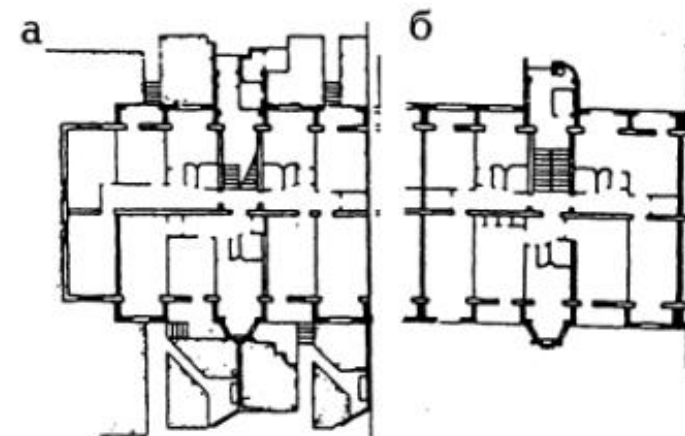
Модернизация планировки 5-этажного дома с устройством приквартирных садов: а – план первого этажа торцевой секции, б – план рядовой секции второго этажа
